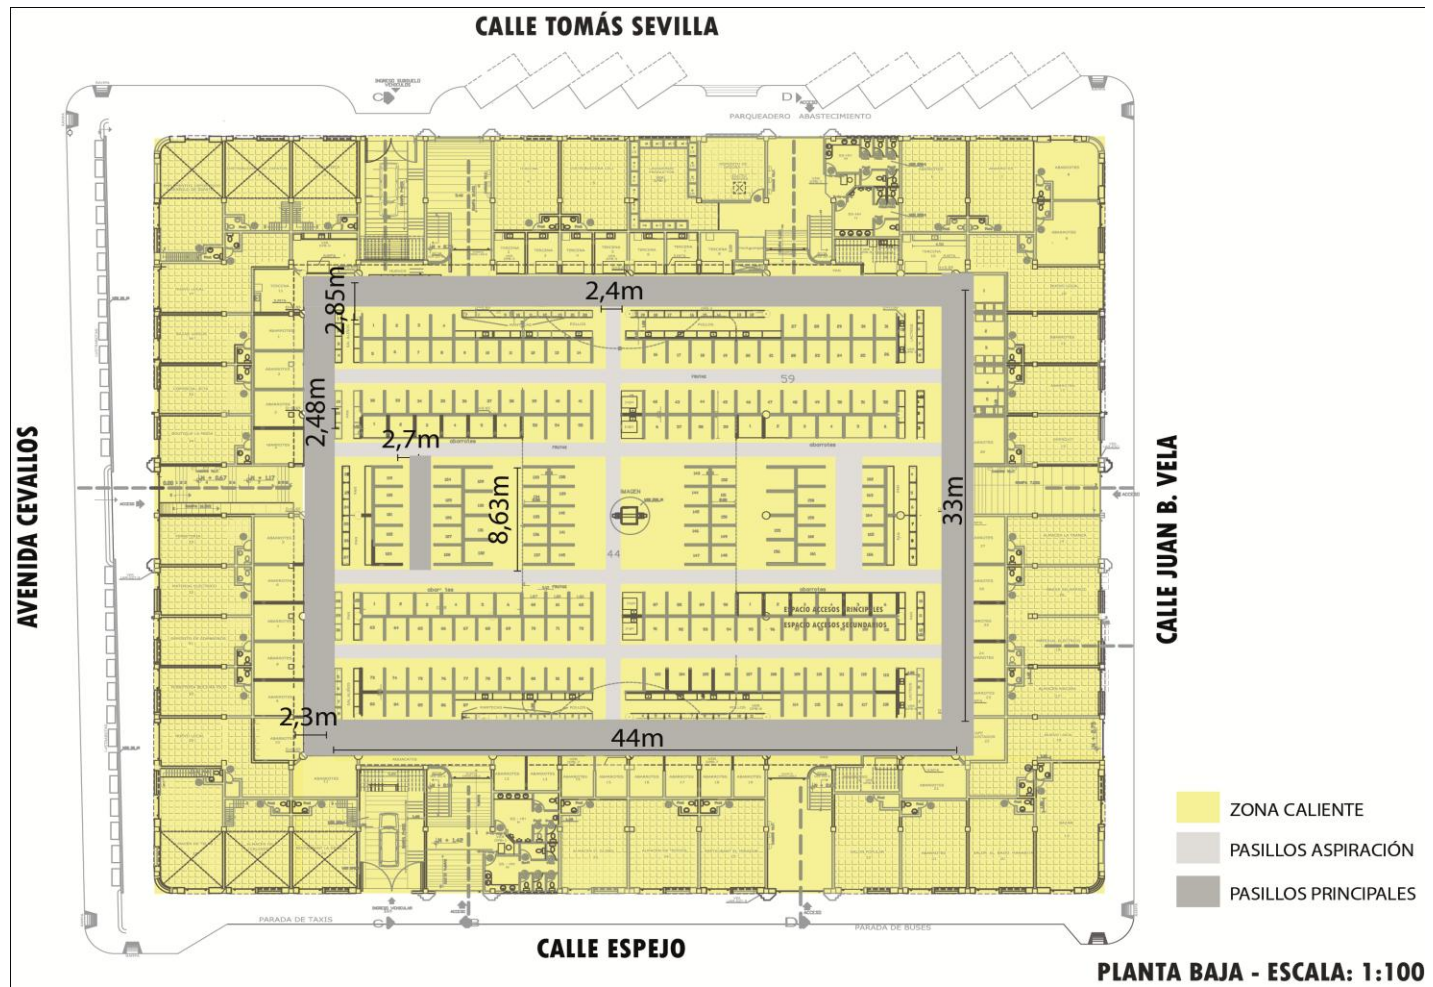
Zonas y pasillos planta baja Mercado Modelo
